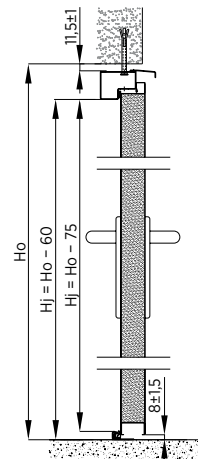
Montage mural d'un bloc-porte à un battant avec bâti intérieur - coupe verticale
